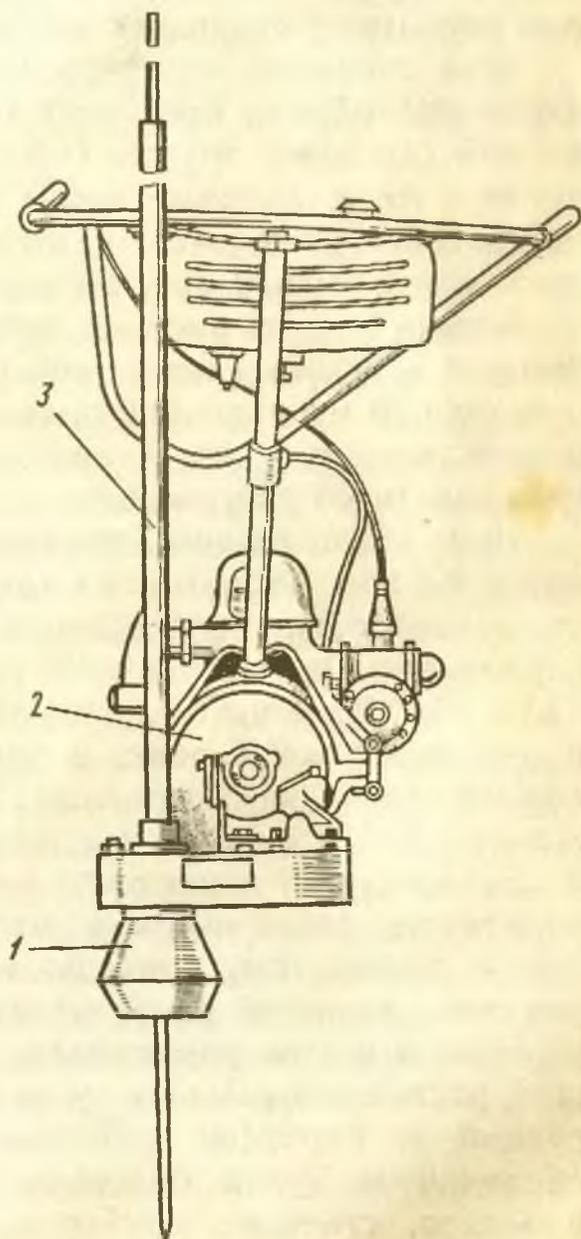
Приспособление для ввертывания электродов заземления ПЗД-12:
